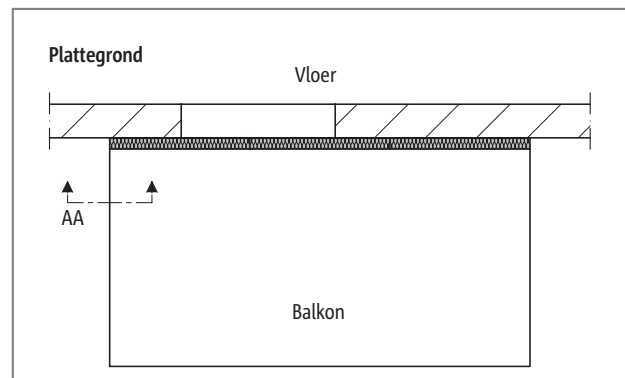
Schöck Isokorb® CT type K-T: bijlegwapening bij indirecte ondersteuning
